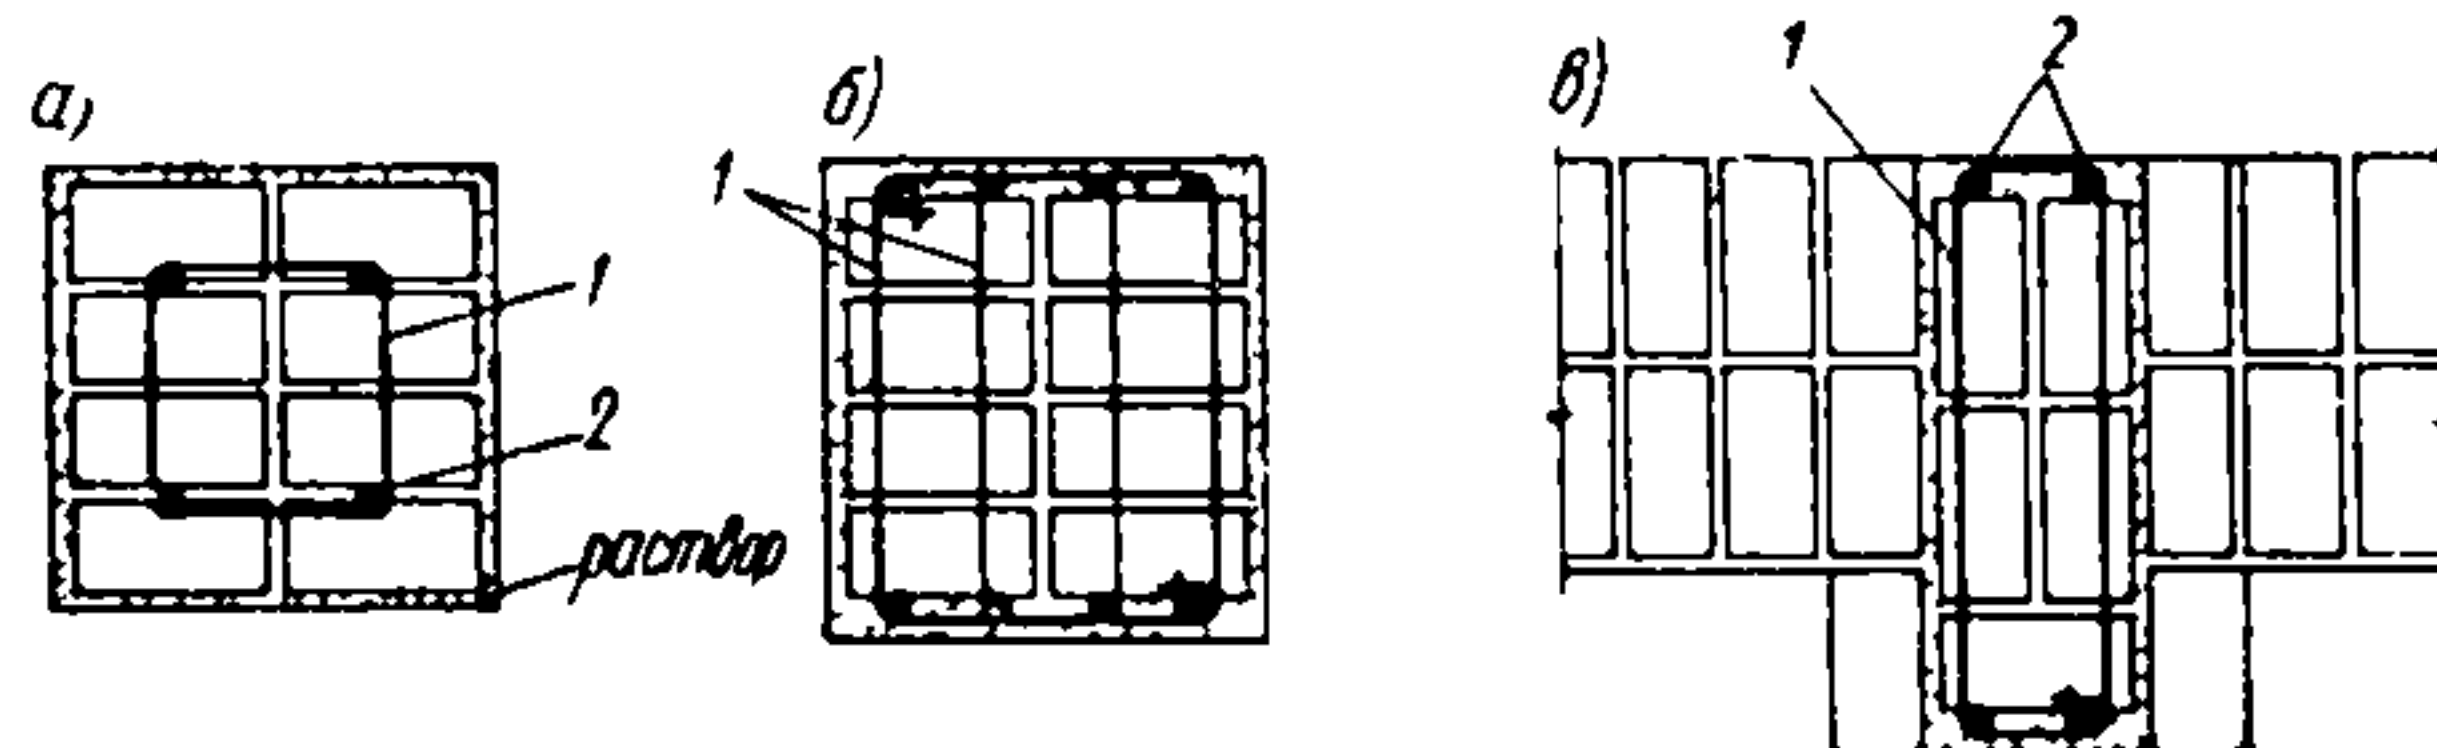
Продольное армирование кирпичных конструкций (столбов, стен и др.)
